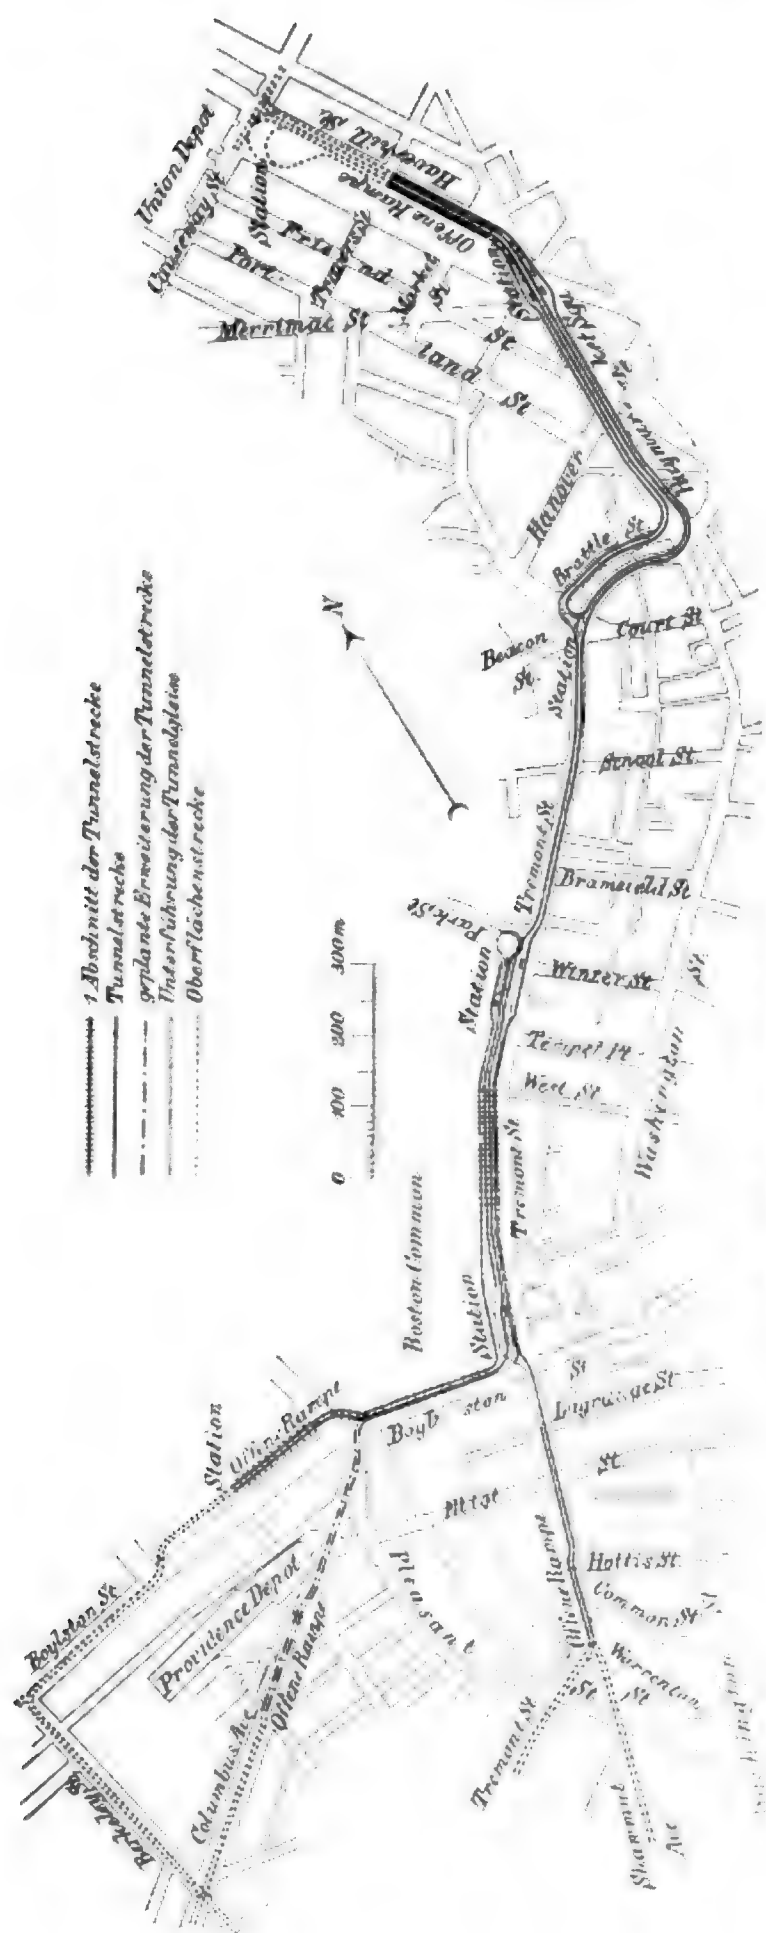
Plan der Tunnelanlagen für die elektrischen Strassenbahnen.
